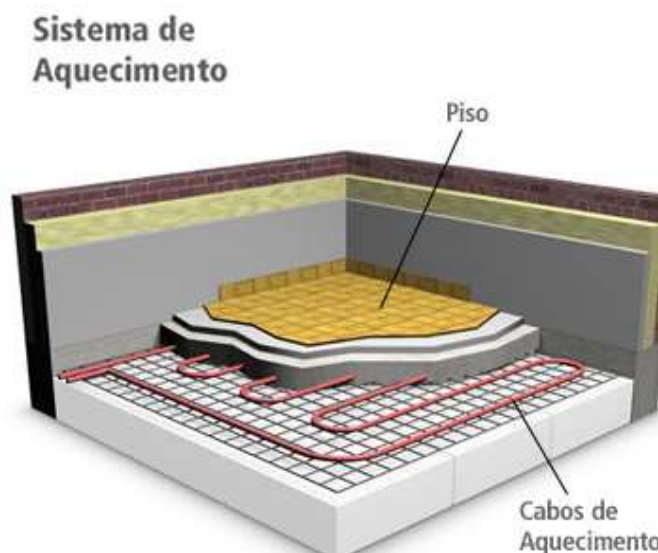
Sistema de piso aquecido (TECH HOUSE SYSTEM)
